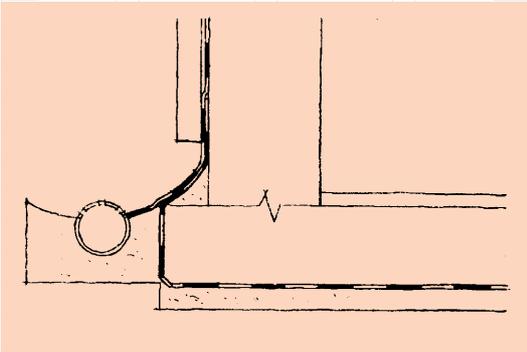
Aussenseitige Abdichtung mit Dichtungsbahnen unter der Fundamentplatte (Neubauten)
